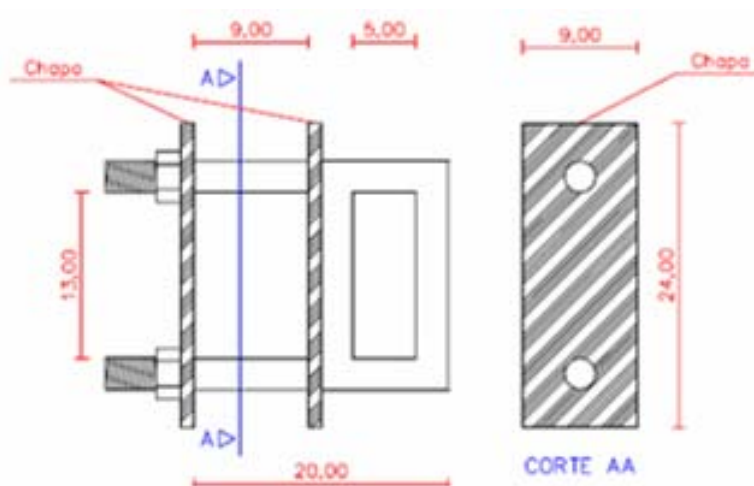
Detalhamento do sistema de ancoragem dos estais (medidas em centímetro).
